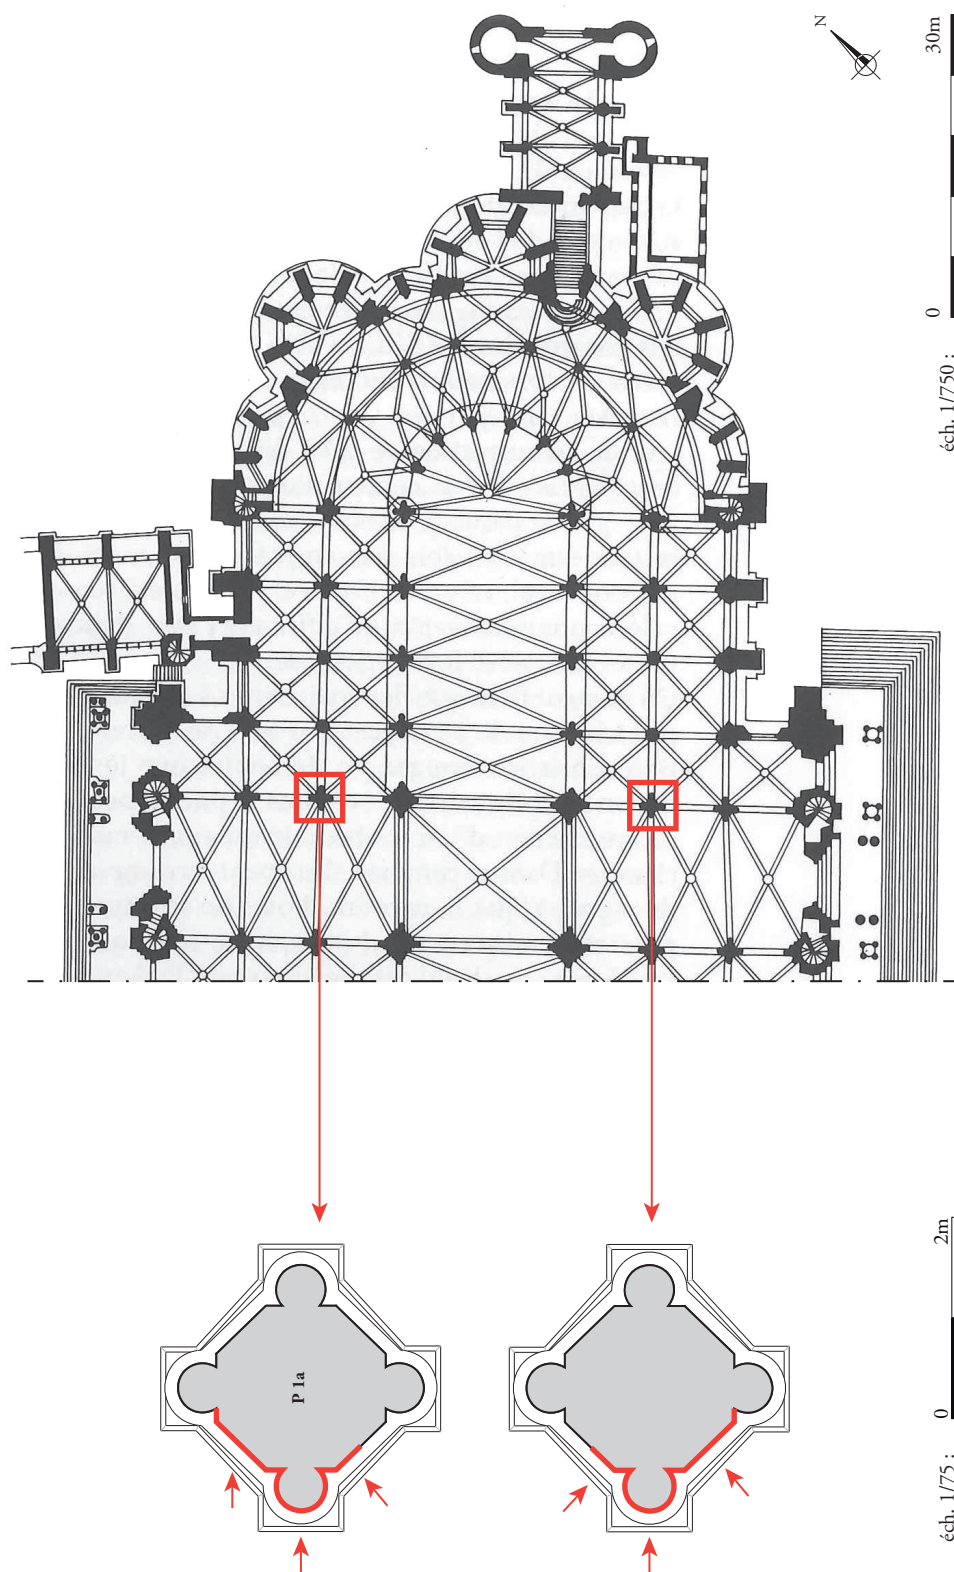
Localisation des anomalies sur les piliers OUEST qui séparent les collatéraux NORD et SUD du chœur – plan d'après Kürmann-Schwarz, Kürmann 2001, échelle : 1/750.
